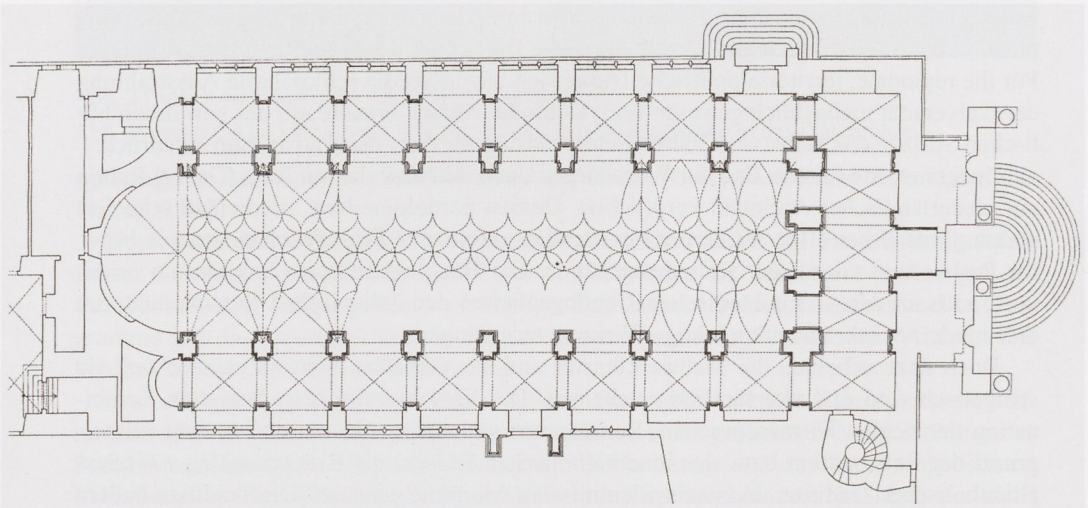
Neubaukirche Würzburg, Grundriss mit rekonstruierter Gewölbefiguration, nach Reinhard Helm
